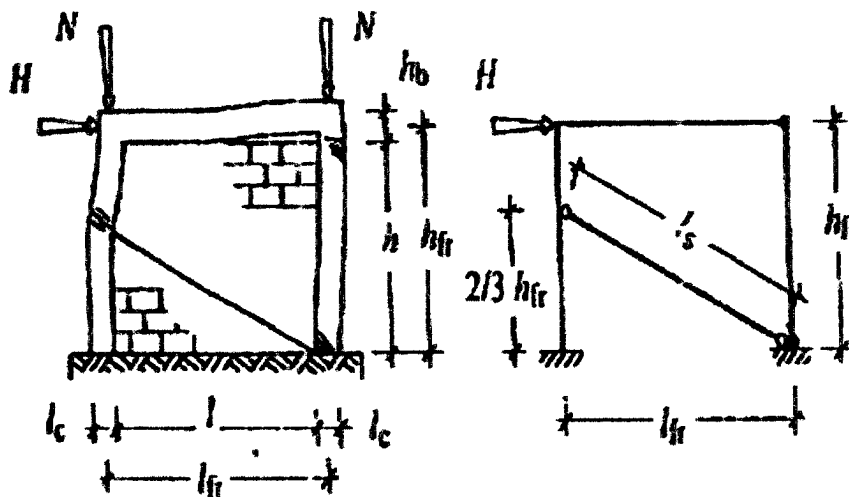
Comportamiento sísmico después de la separación de la mampostería del pórtico de concreto armado. (Tomazevic, 1998).
